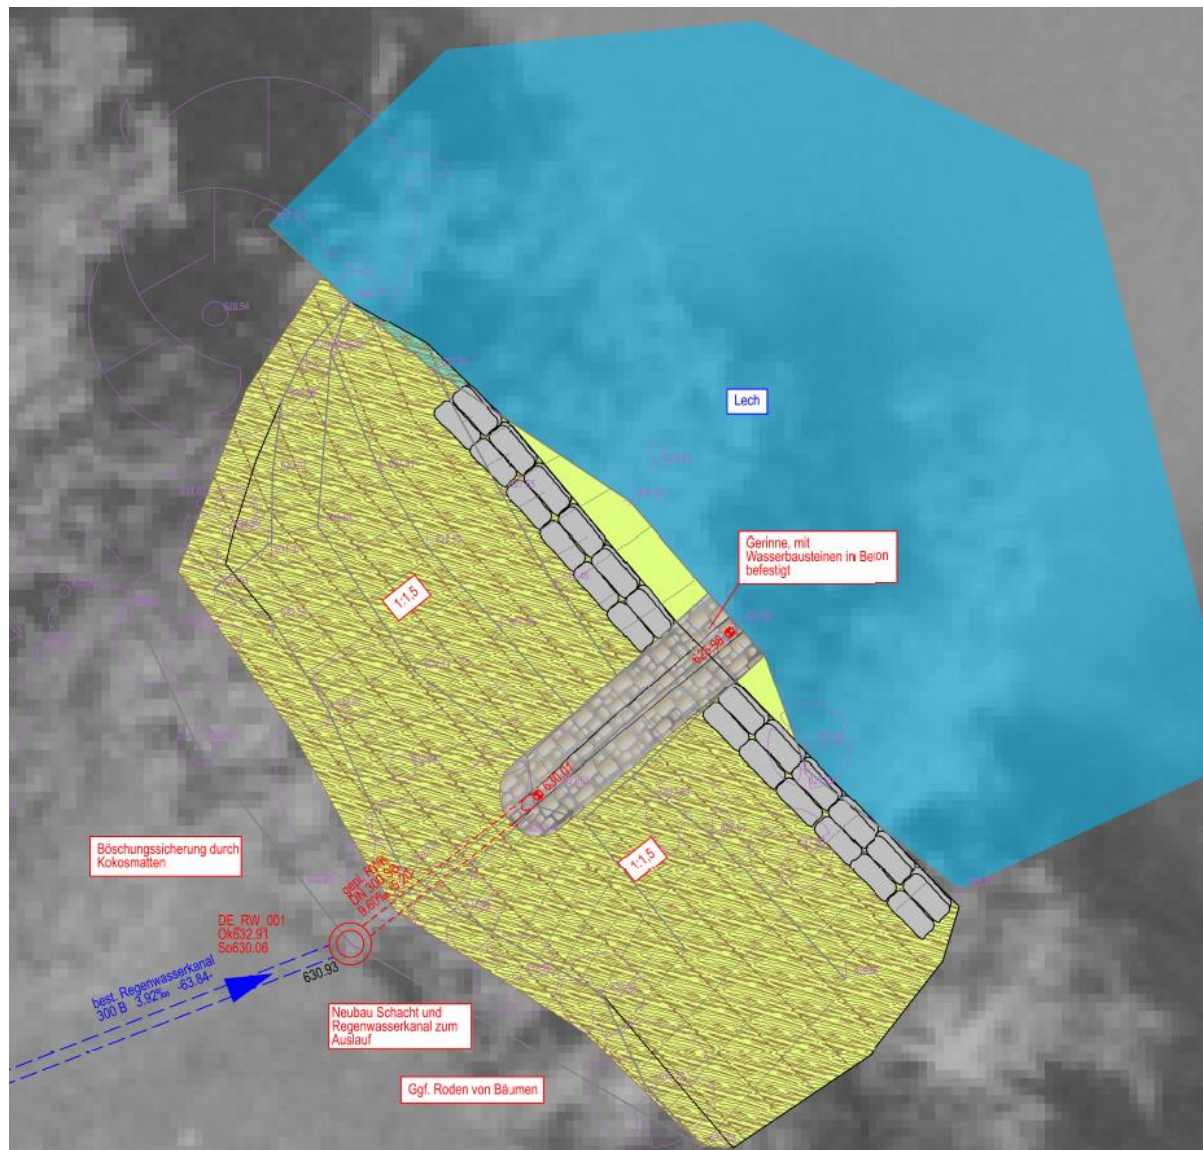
Ausschnitt aus Lageplan 118127-03-HW
